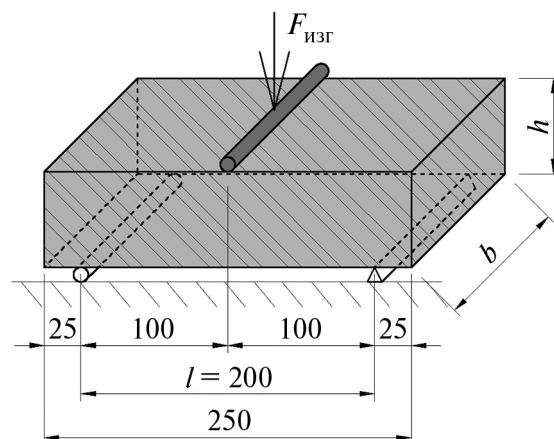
Схема испытания кирпича на изгиб: $F_{изг}$ — изгибающая нагрузка; b , h — размеры поперечного сечения
